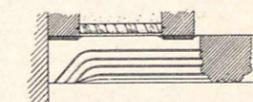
Unterzug im Obergeschoß des Stallflügels. 1:40.
